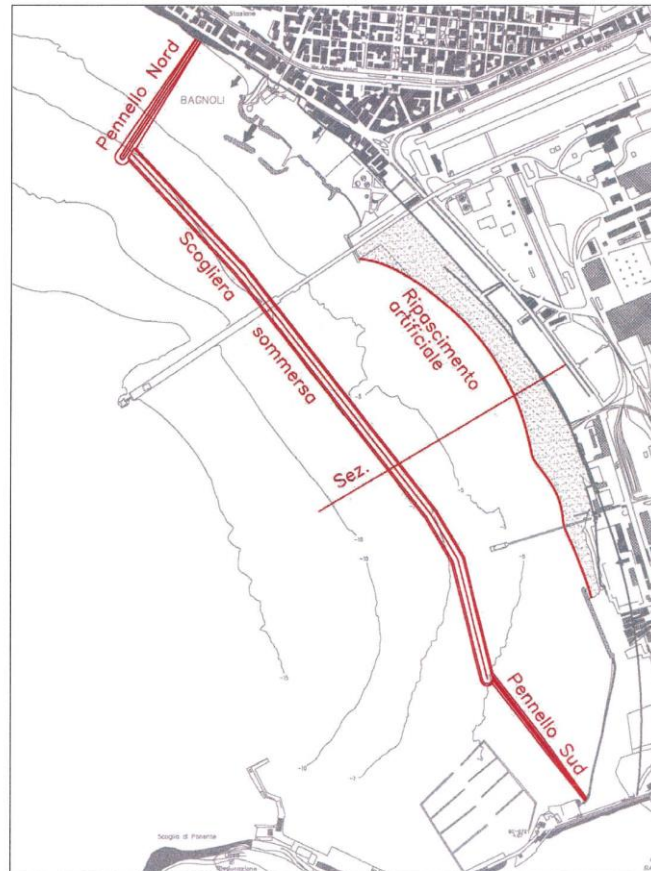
Planimetria generale di progetto proposta dal Prof. Calabrese nel 2008
